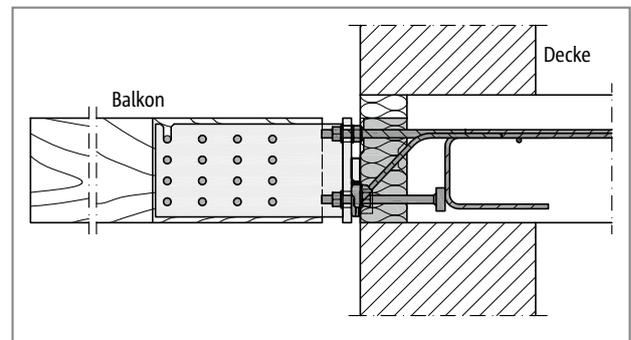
Schöck Isokorb® T Typ SK mit Stahlschwert: Anschluss an die Stahlbetondecke bei monolithischer Außenwand
